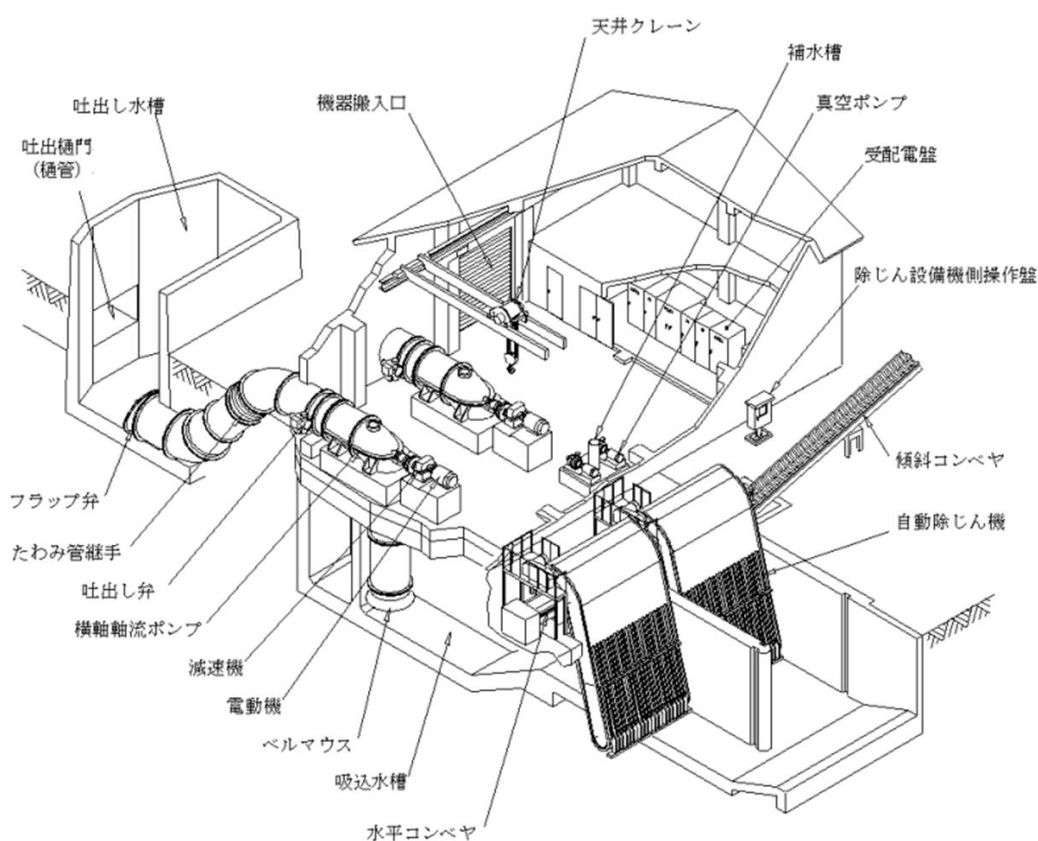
ポンプ場（排水・横軸軸流ポンプ）の施設（例）
